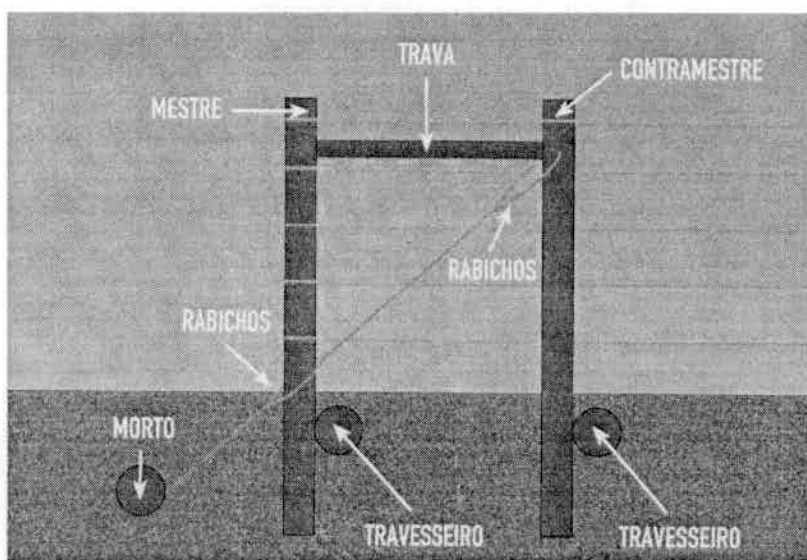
Detalhe do espaçamento entre mestre-contramestre, ou mestre-palanques na execução de cantos duplos sem ângulo, cantos duplos com ângulo e ancoragens
